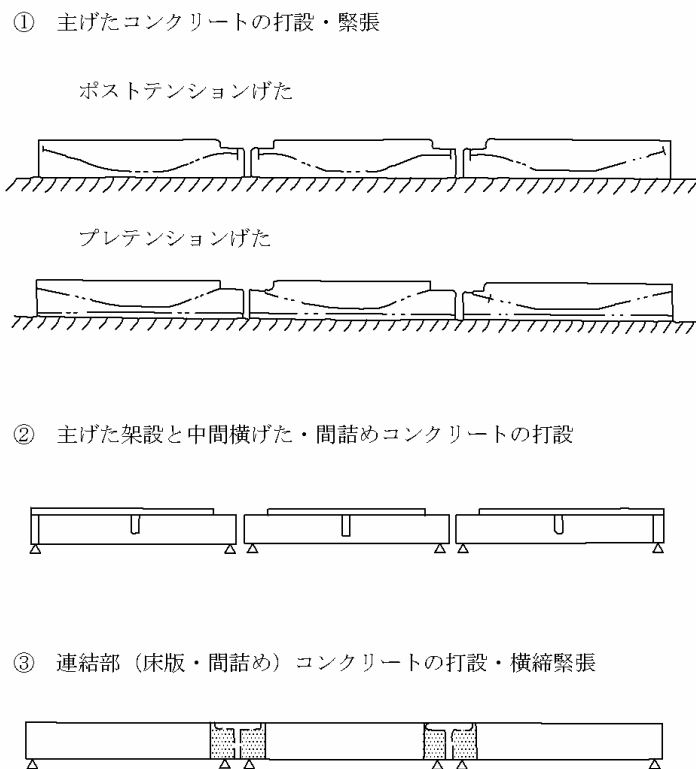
プレキャストげた架設方式連続げた橋の一般的な施工手順
